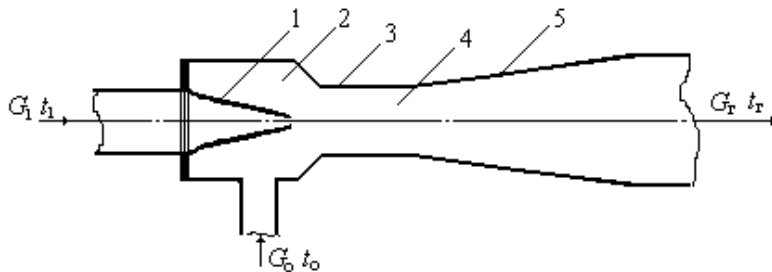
Схема водоструйного элеватора: 1 – сопло; 2 – камера всасывания; 3 – смесительный корпус; 4 – горловина; 5 – диффузор.
